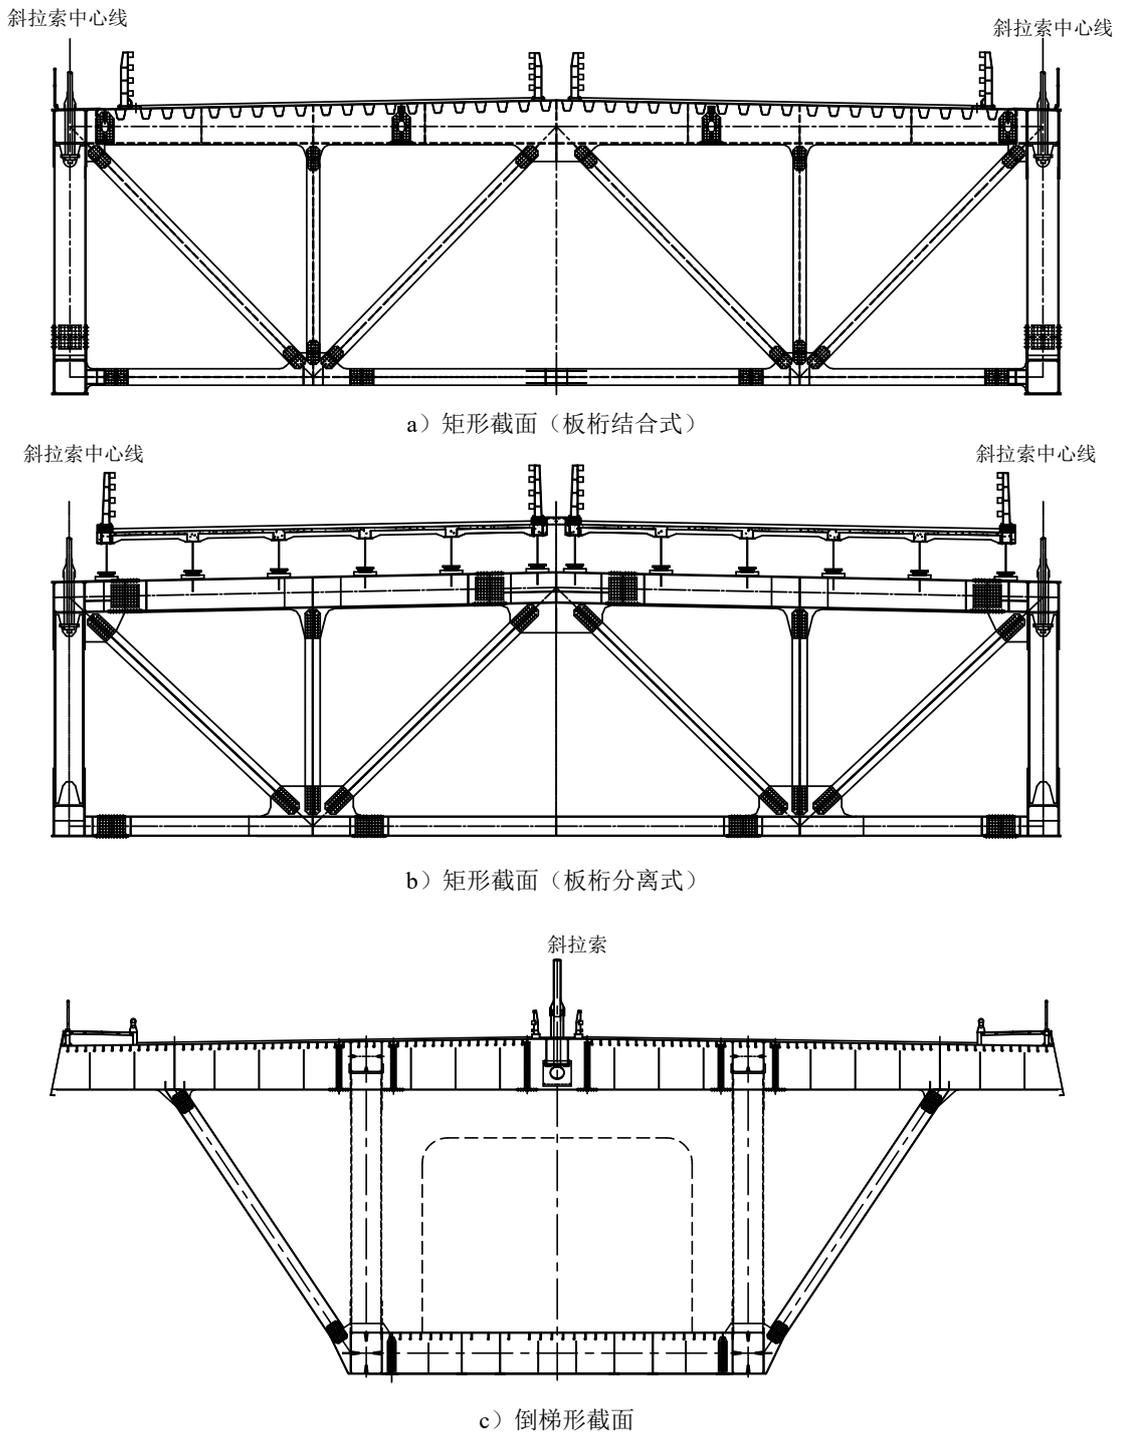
钢桁梁斜拉桥典型截面示意
